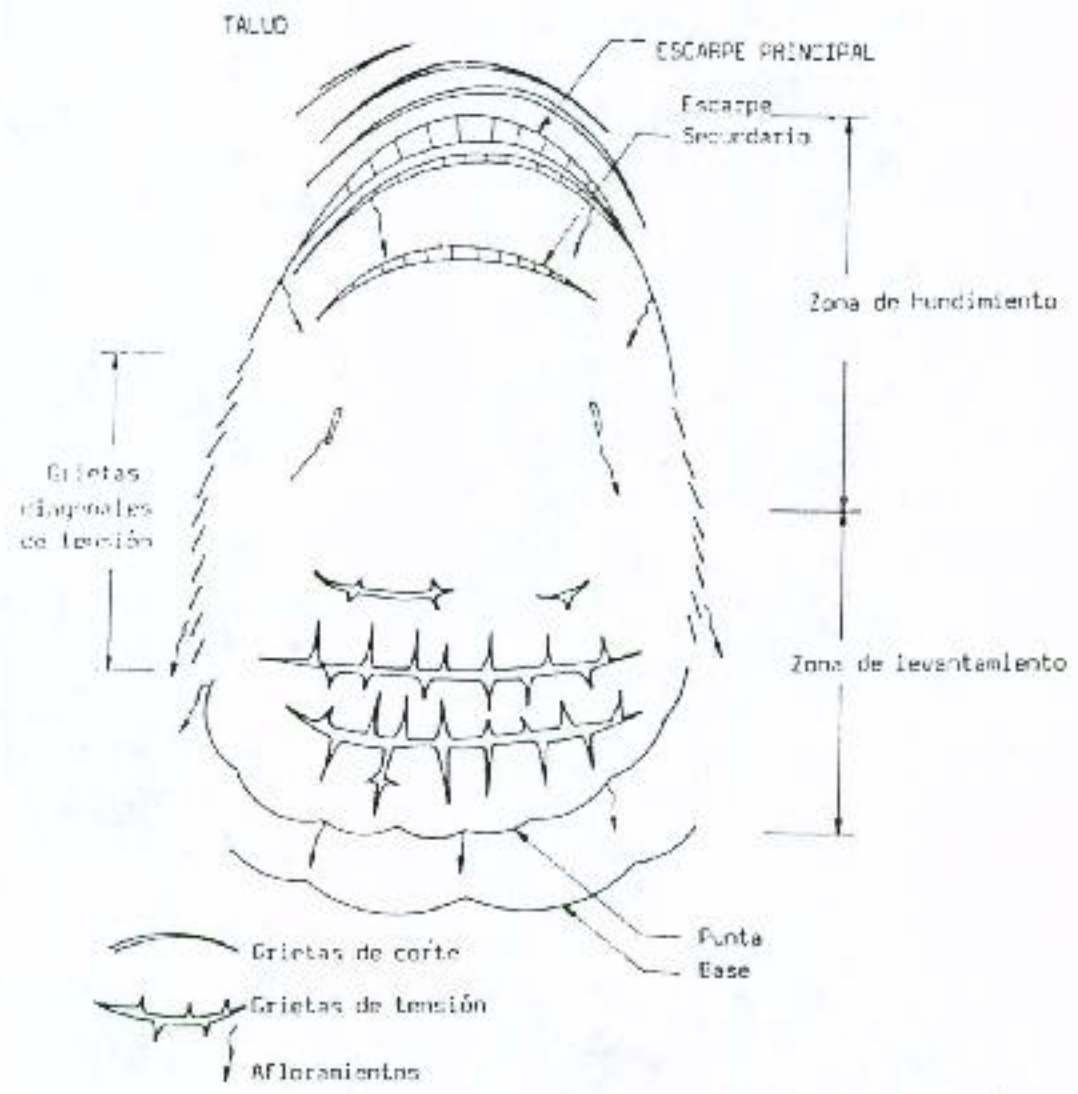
Agrietamientos y planta en un derrumbe rotacional
